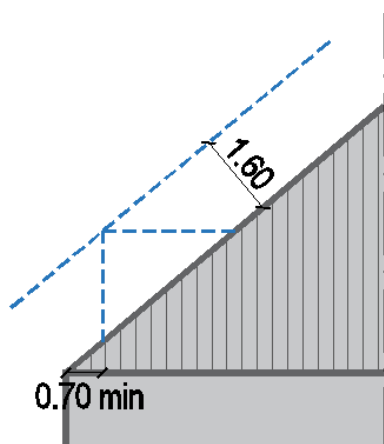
Lucarnes implantées en recul sur l'alignement de la façade.
